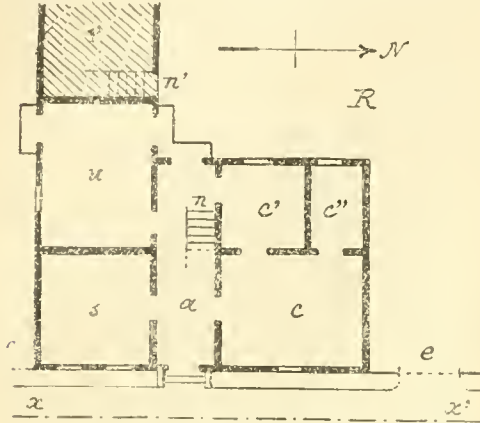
Plan d'une habitation rurale de la vallée de la Sambre. (Echelle de 0^m.004 par mètre).
